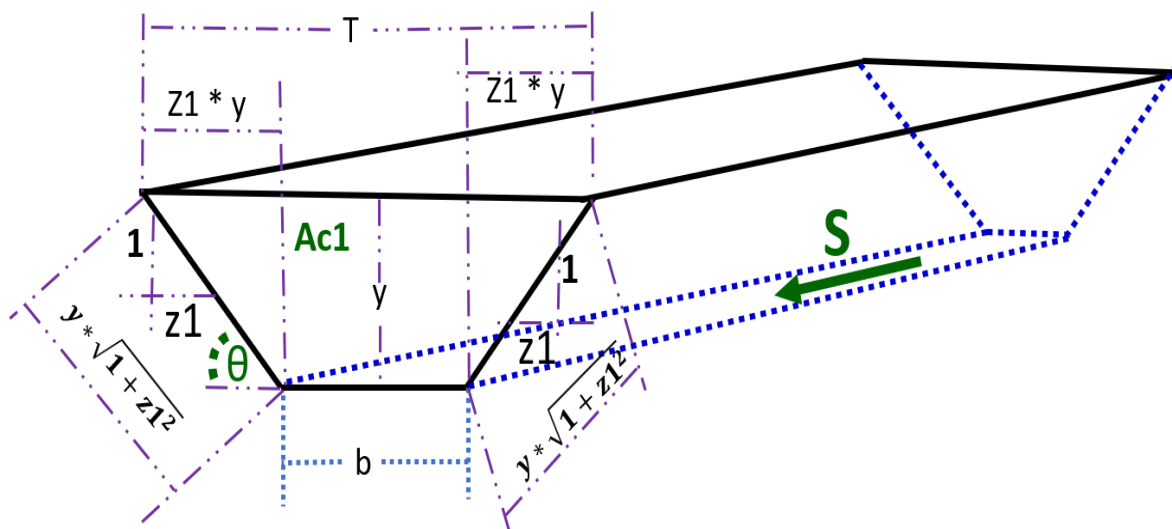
Sección transversal de un canal trapezoidal donde se tiene un talud único “ $z = z1$ ”
